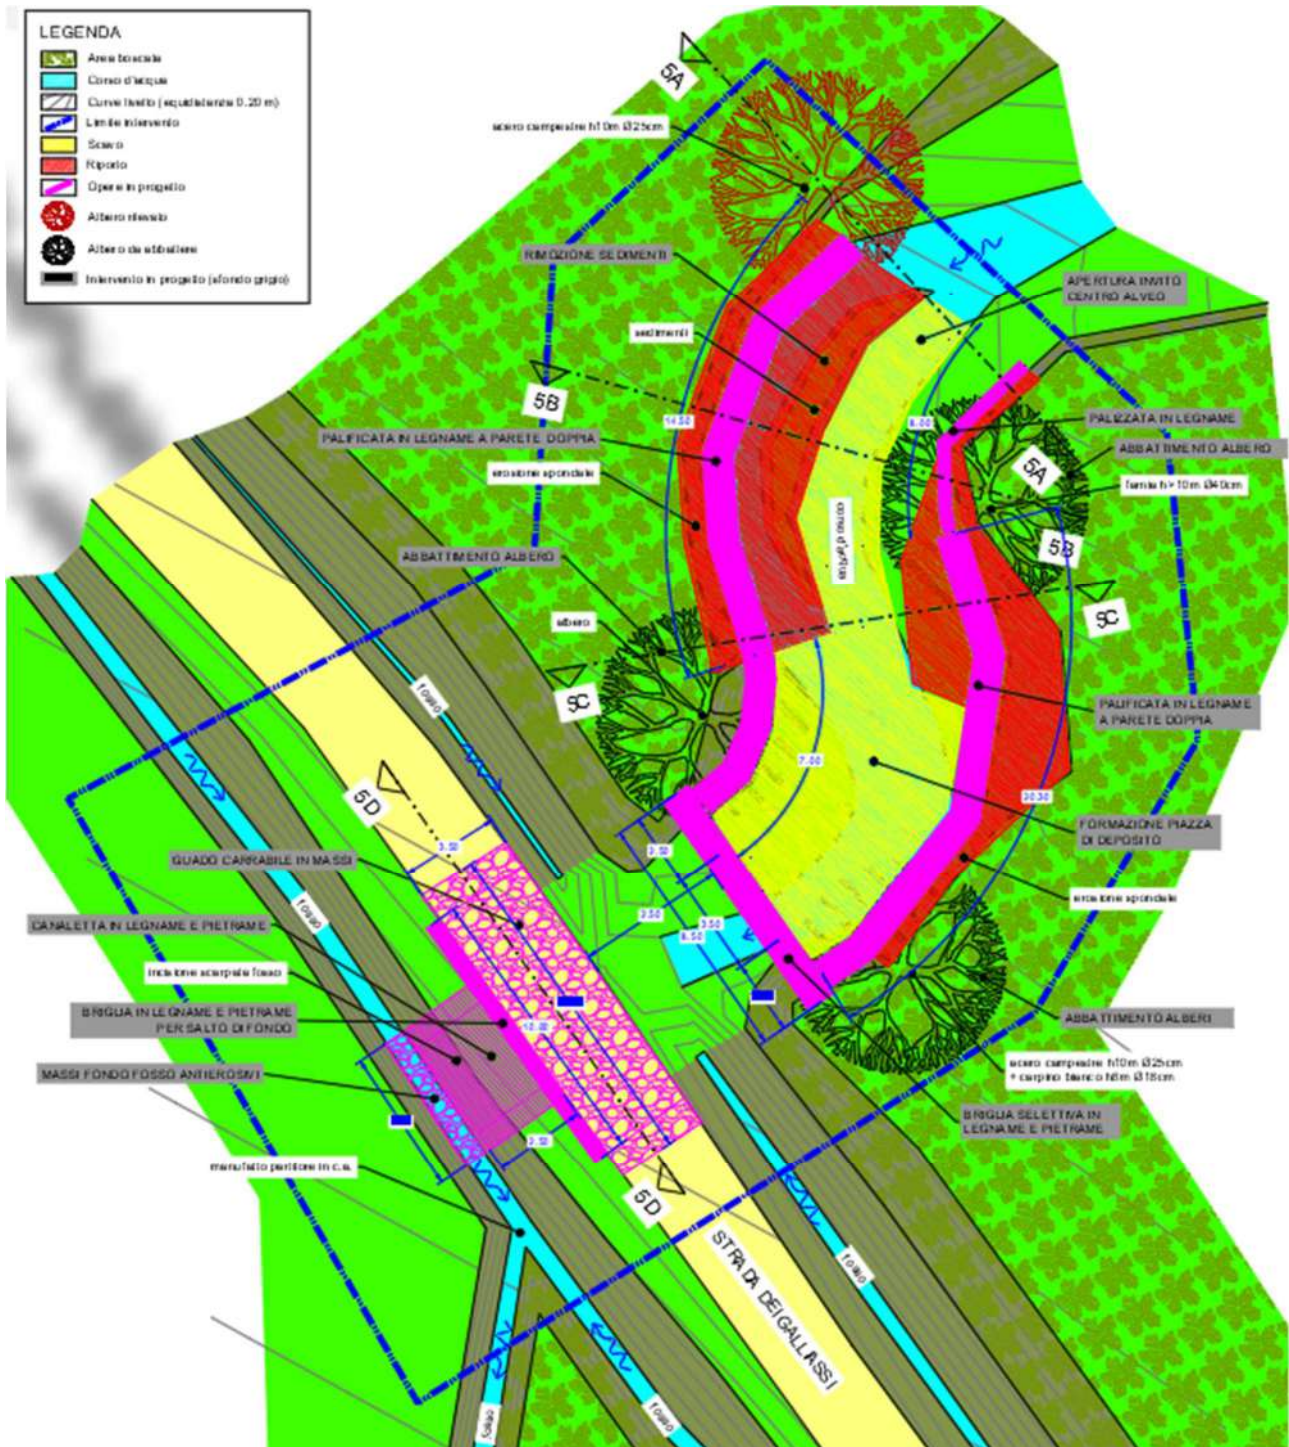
Planimetria di progetto. (rappresentazione non in scala)
